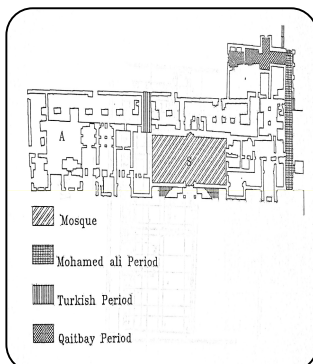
مسقط أفقي للدور الأول لمصنع الكسوة
